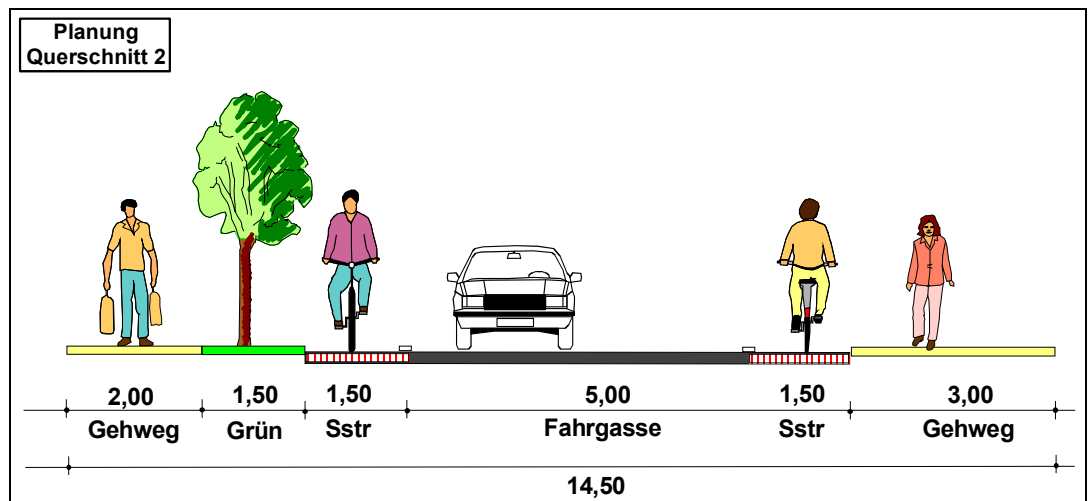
Abschnitt 2 – Planung für Abschnitte ohne Parkstände
